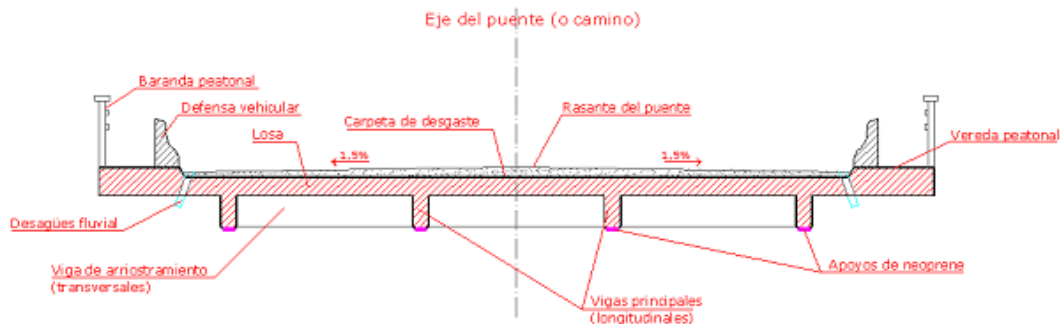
Corte de ejemplo (Fuente: apuntes de Hormigón Armado II)
